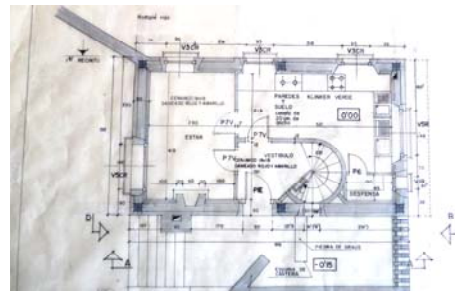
Planta baja casa El Chuego. Archivo de Heliodoro Dols Morell
